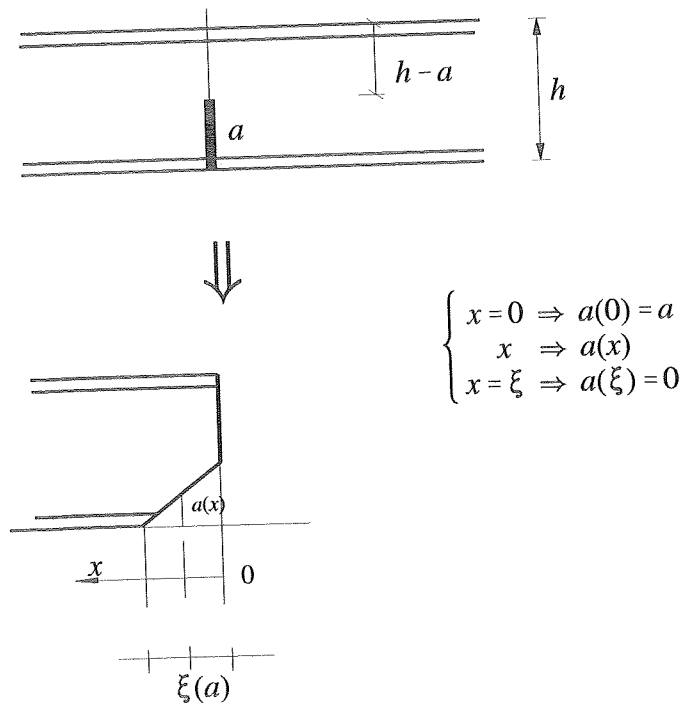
Desenvolvimento da Fissura na Viga.
